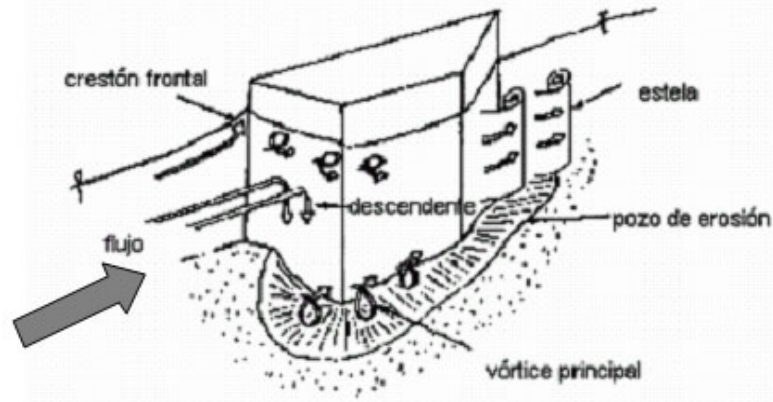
Sistema de Vórtices durante la erosión en un Estribo
